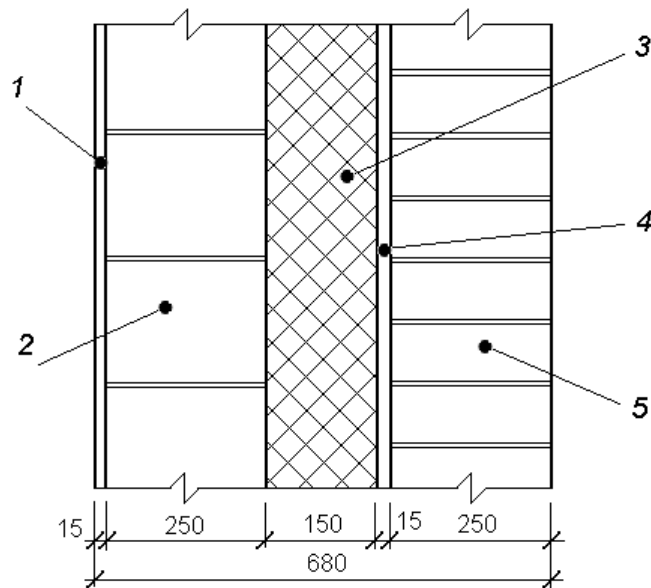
Расчетная схема наружной стены с невентилируемой воздушной прослойкой: 1 — внутренняя штукатурка; 2 — внутренний слой кирпичной кладки; 3 — теплоизоляция; 4 — невентилируемая воздушная прослойка (технологический зазор); 5 — лицевой кирпичный слой
